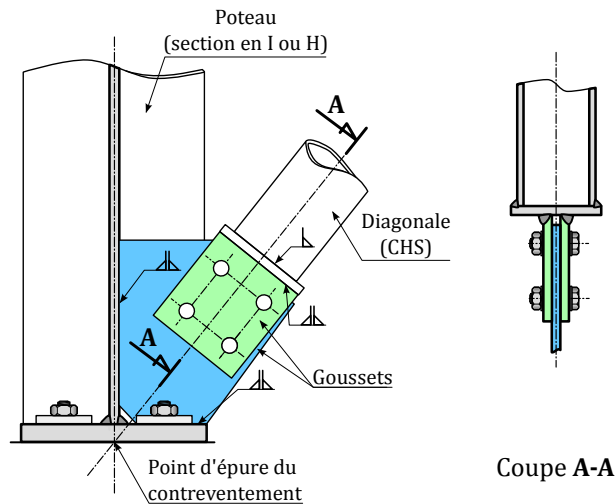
Assemblage d'un profil creux par gousset – Disposition alternative
